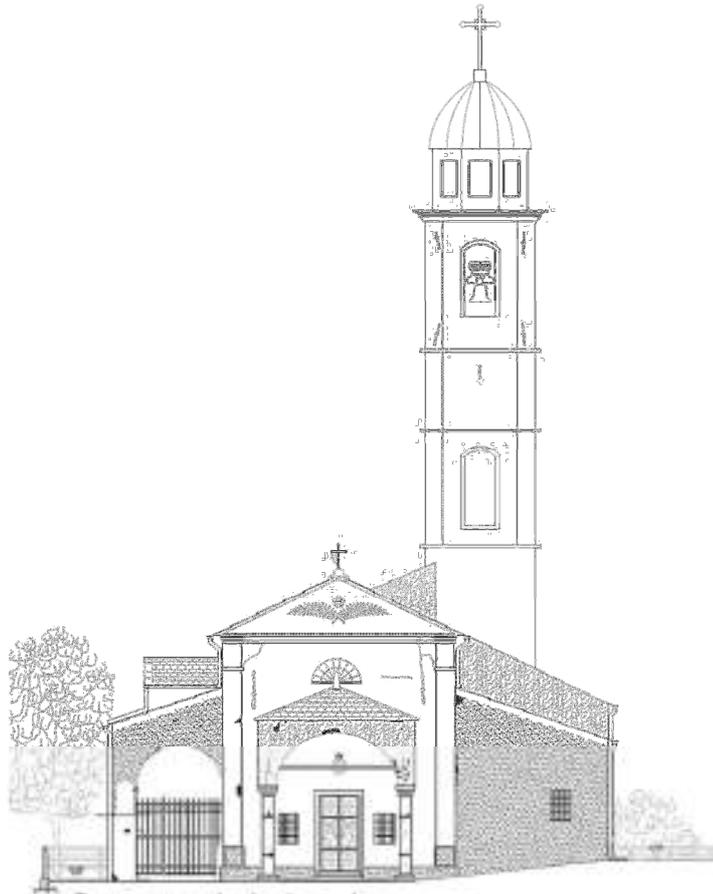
Prospetto anteriore nord (Fonte: Tavola 3C)
